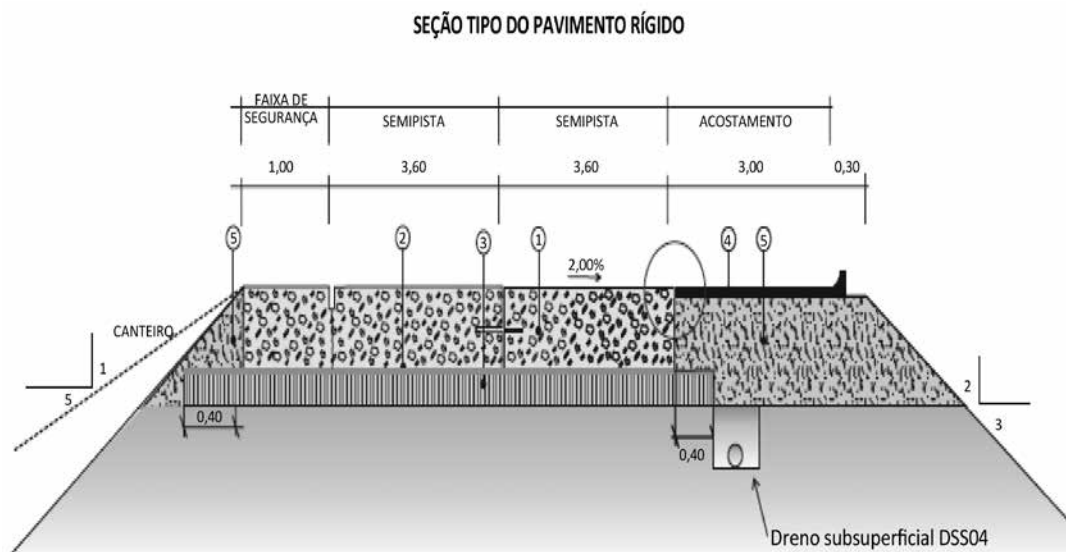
Seção tipo da seção transversal do pavimento rígido
